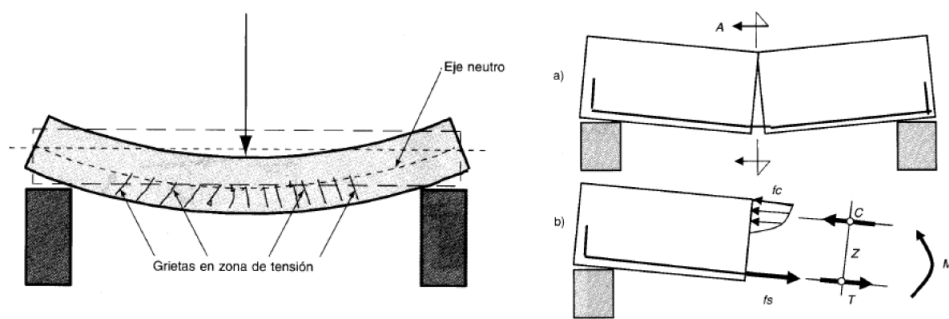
Viga típica simplemente reforzada y par de fuerzas
